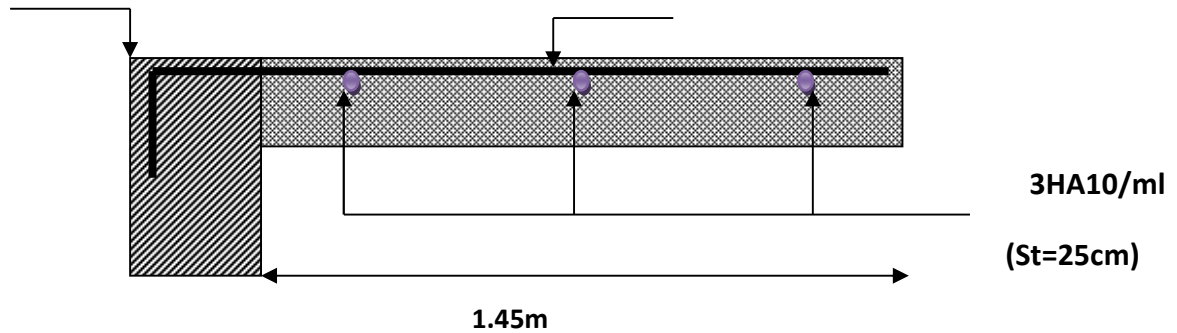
schéma de ferrailage de la volée (II) d'escalier type 1
